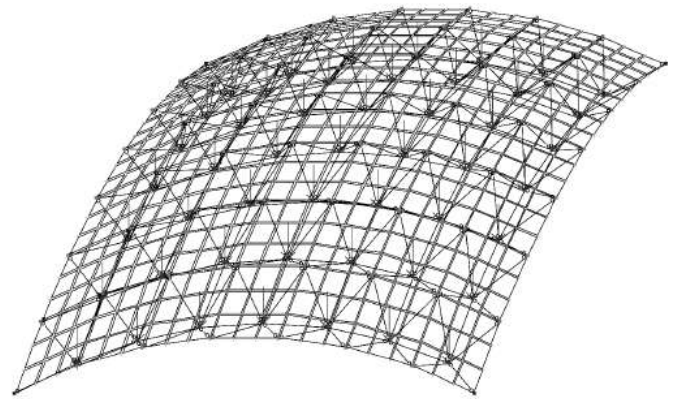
Схема завантаження оболонки у вузлах нижнього пояса
